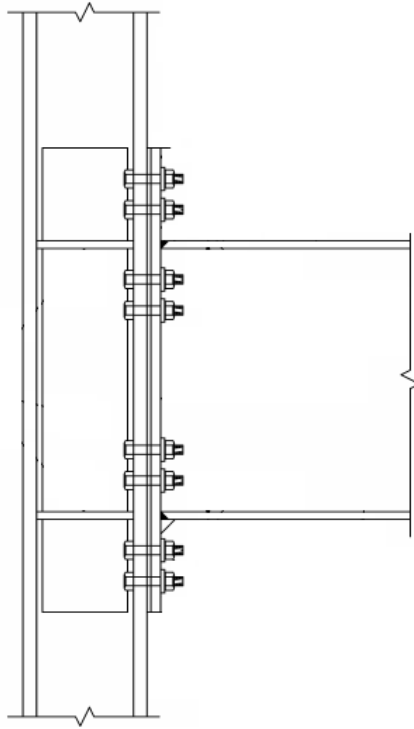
d. Assemblage par platines d'à bout raidies soudées à la poutre et boulonnées à l'aile du poteau par 8 rangées de boulons.
